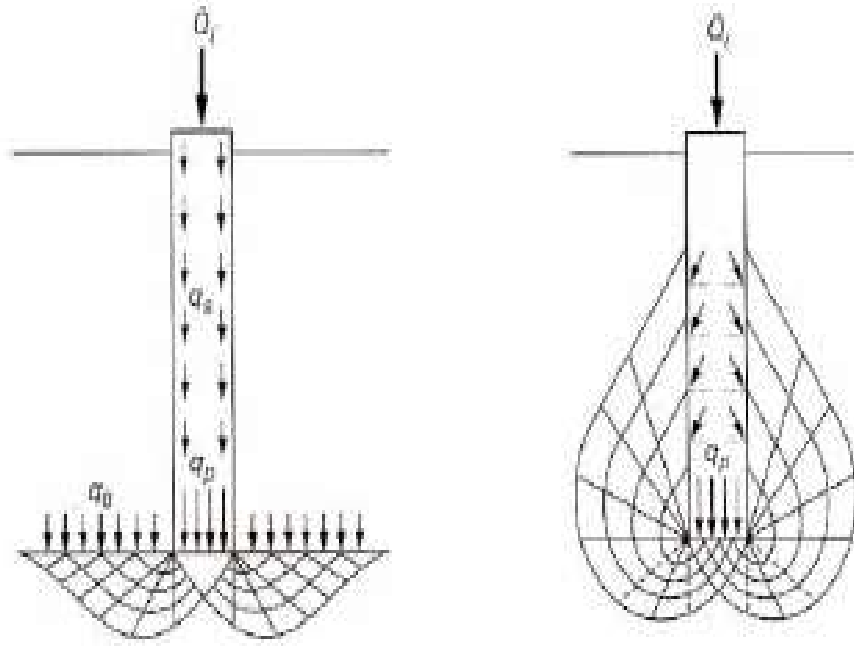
Charges de rupture et de pointe pour une fondation profonde
